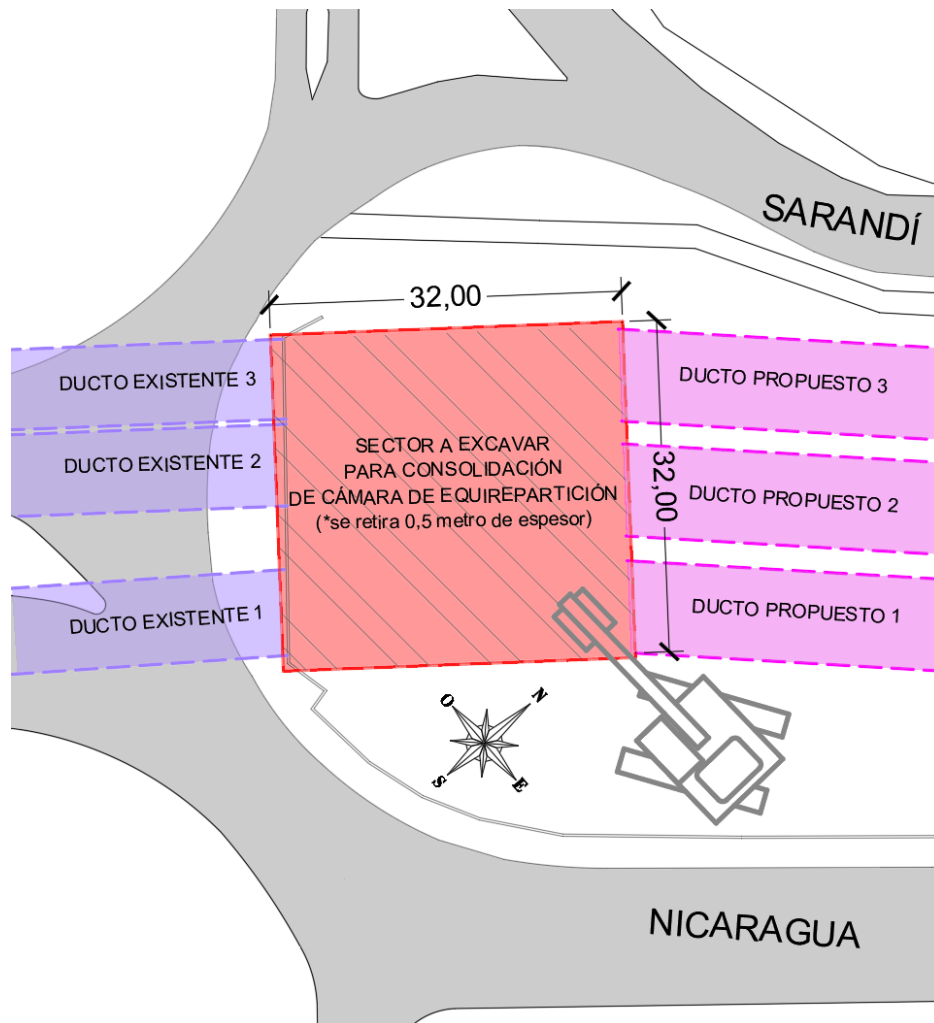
Cámara de Equirepartición-Excavación de suelo a reemplazar-Planta
